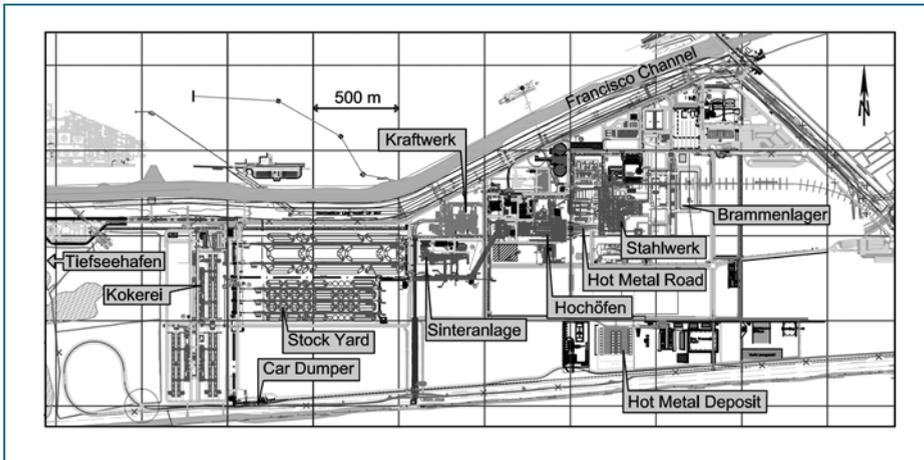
Layout (Ausschnitt) des neuen Hüttenwerks TK CSA Siderúrgica do Atlântico
